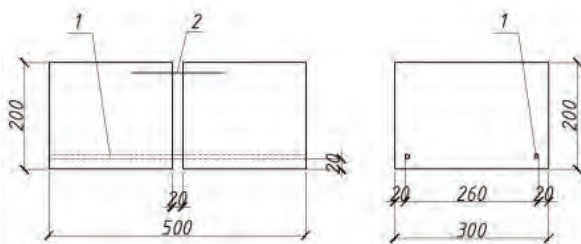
Схема установки композитной арматуры в арболит при испытаниях на выдергивание при изгибе
